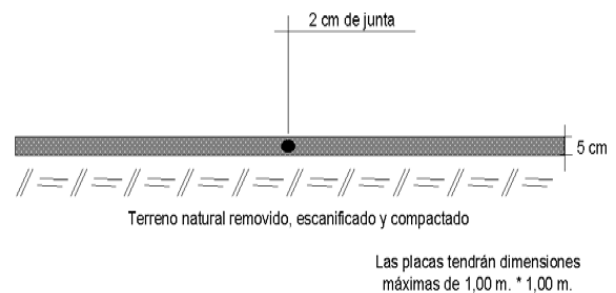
Pavimento en concreto hidráulico con placas prefabricadas
